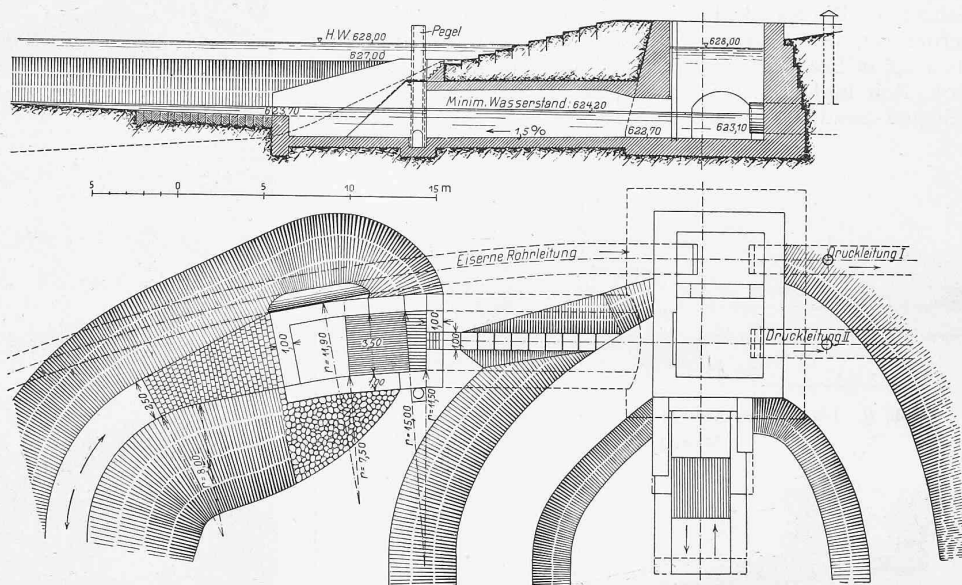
Längsschnitt und Grundriss durch das Wasserschloss der Kanderleitung. — Masstab 1 : 400.
